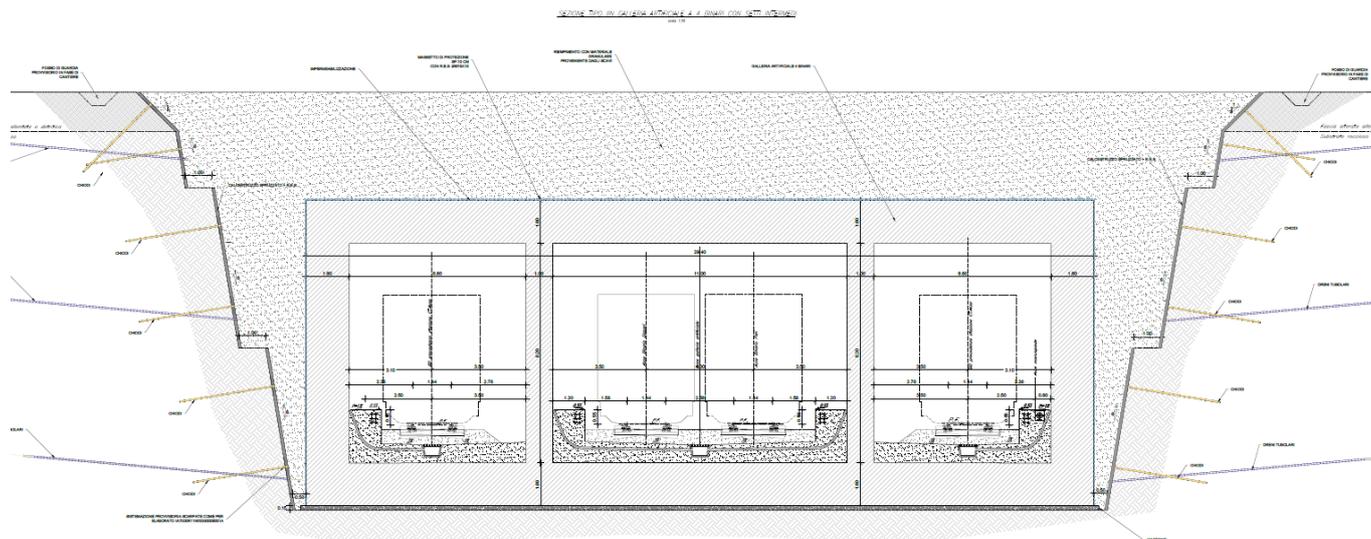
Sezione tipo con Galleria 4 binari con setti intermedi
